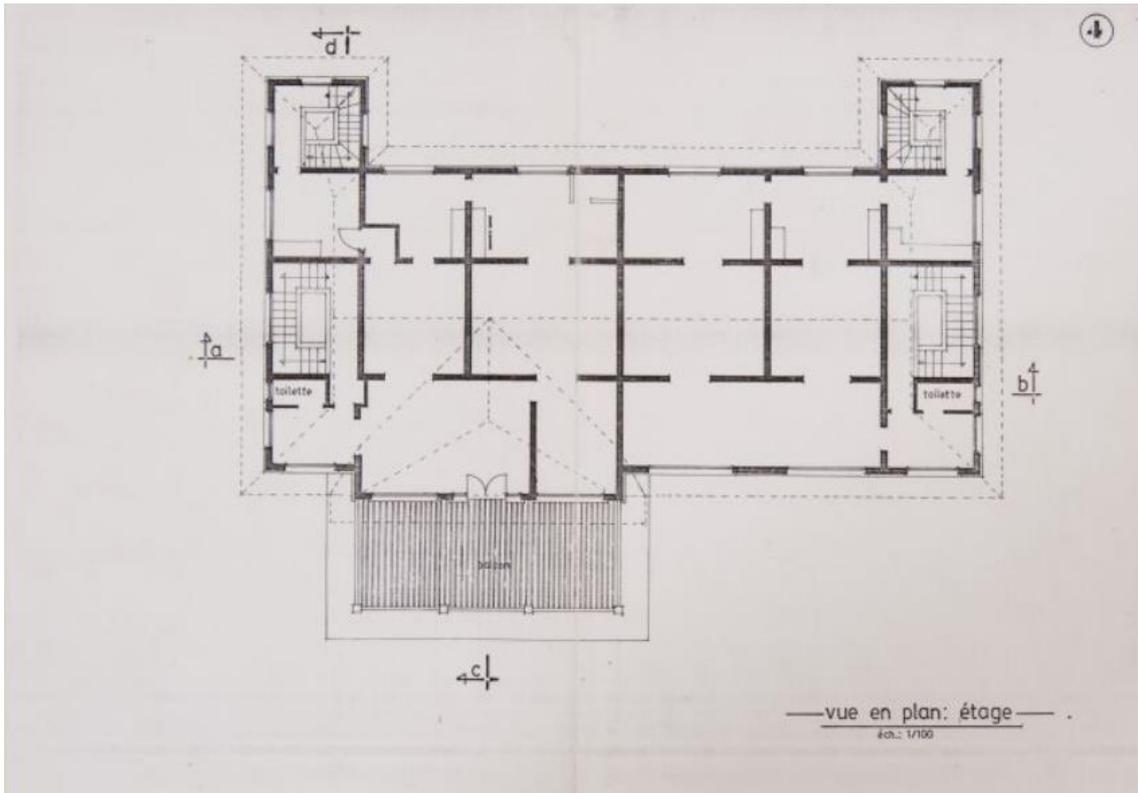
plano de la planta superior de la Casa do Benin, archivo Instituto Bardi
